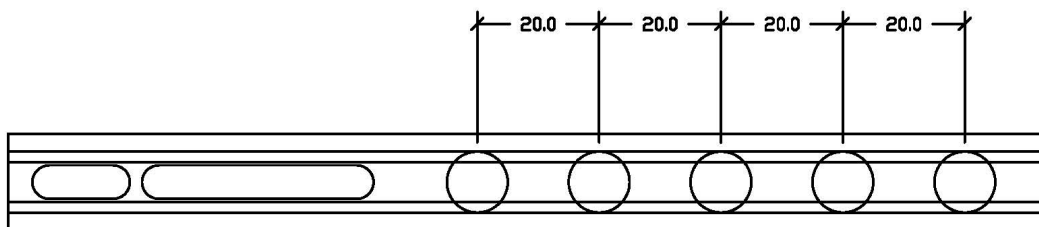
Bestehende Glasauflagerkonstruktion.
